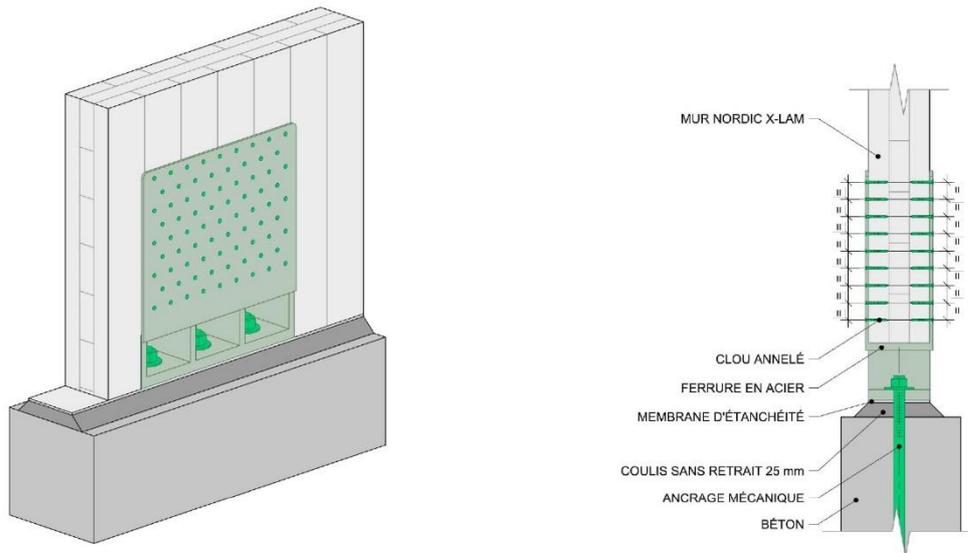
Mur sur fondation, ferrure de type *holdown
